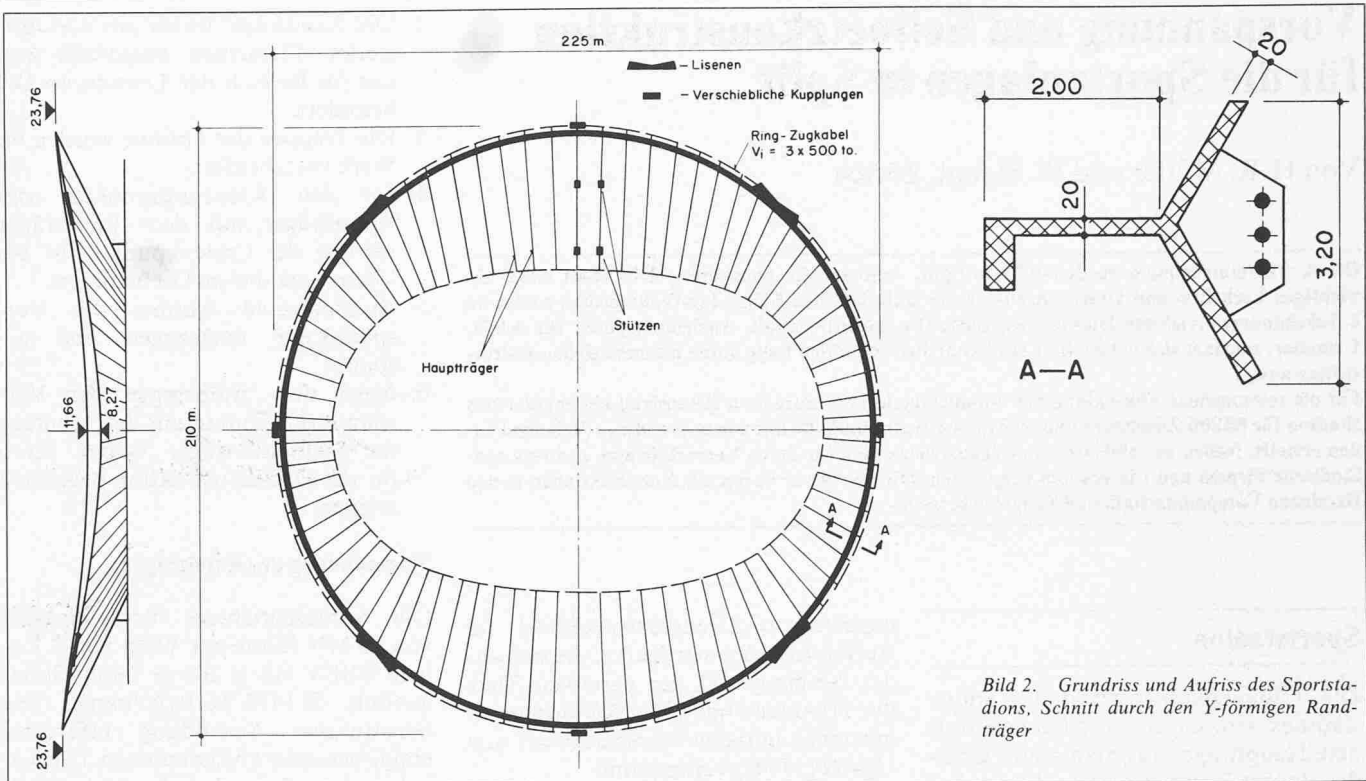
Grundriss und Aufriss des Sportstadions. Schnitt durch den Y-förmigen Randträger
